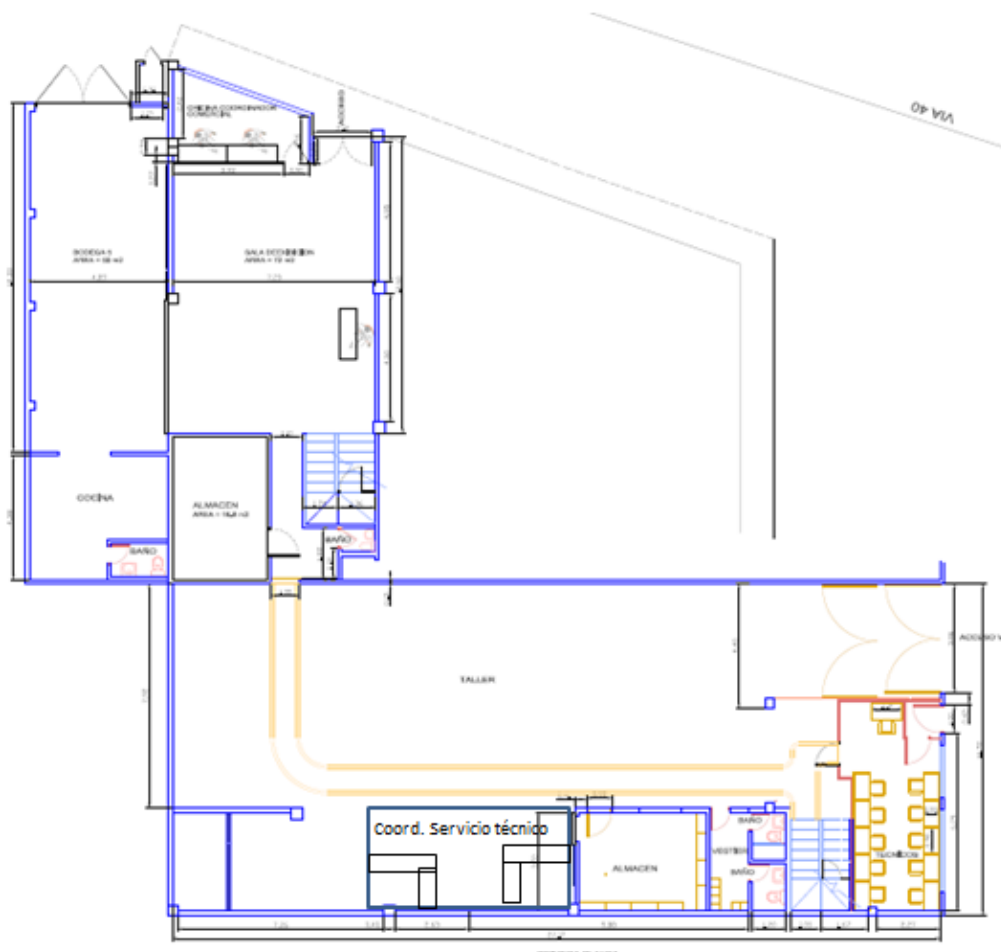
Plano Planta Oficinas Departamento de Servicio Técnico
